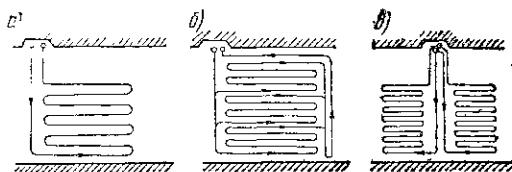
Размещение змеевиков из труб в междуэтажных перекрытиях
